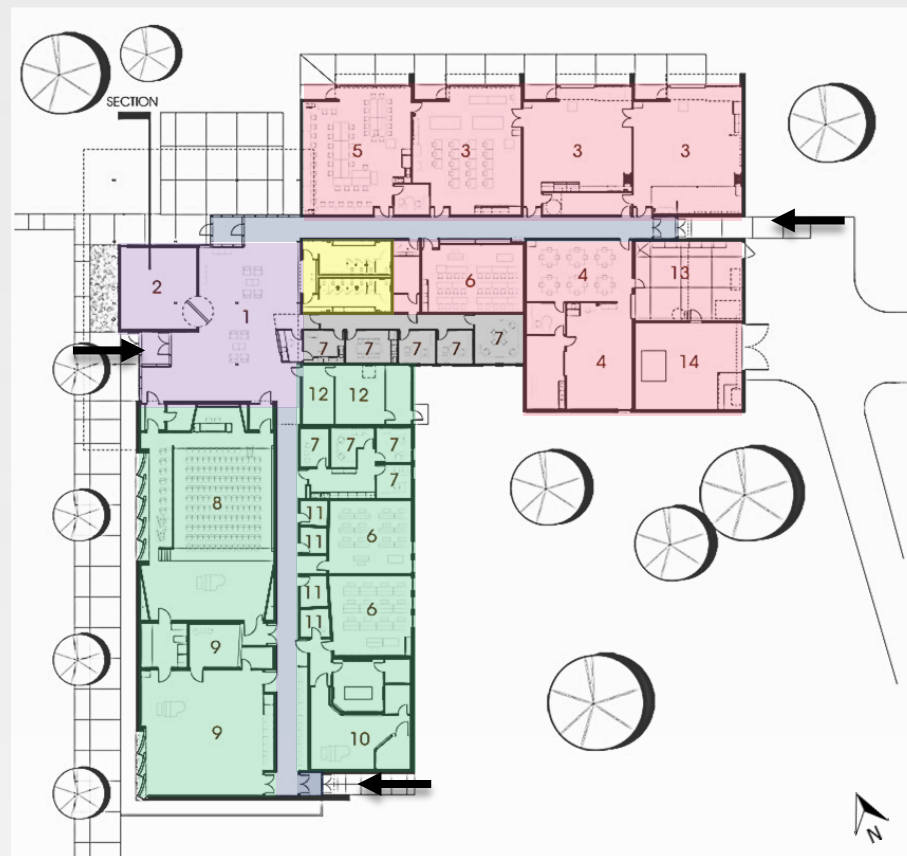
Planta Baixa Zoneamento (INTEGRUS ARCHITECTURE, 2019).
